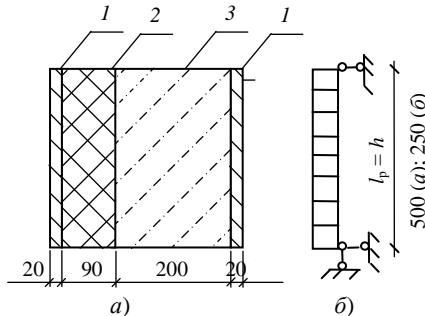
Схемы конструкций стен несъёмной опалубки:
